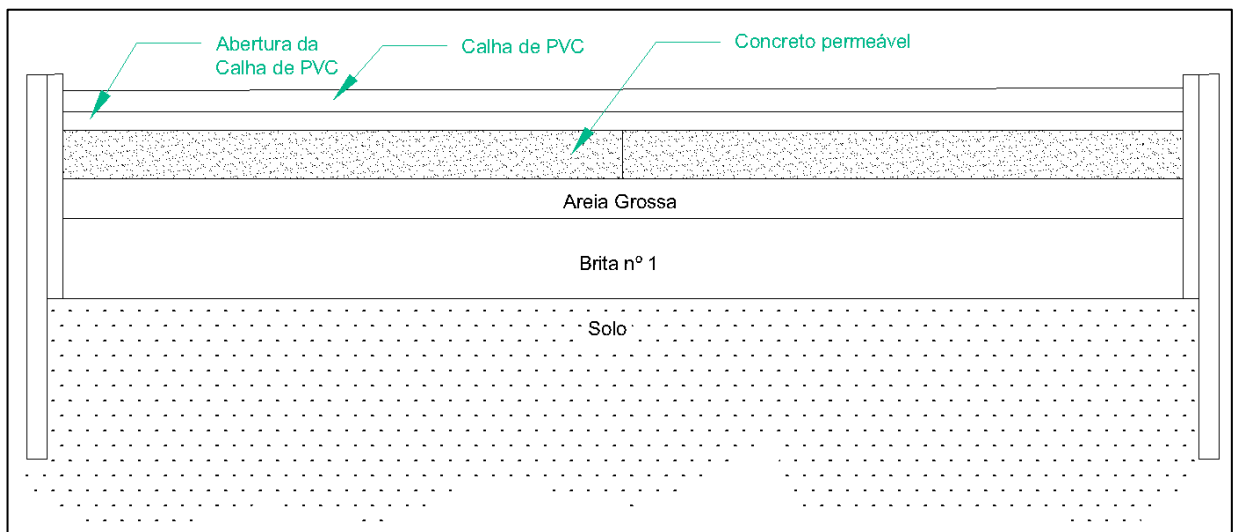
Corte BB' do modelo de pavimento de concreto permeável.
